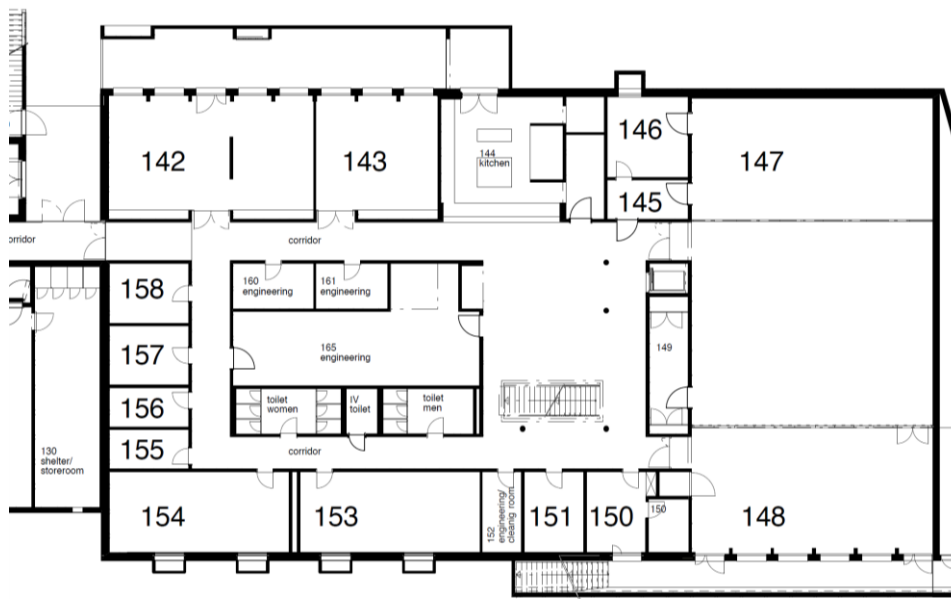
Notausgang des Treffpunkts (Raum 148) im Untergeschoss des Secondary Buildings
